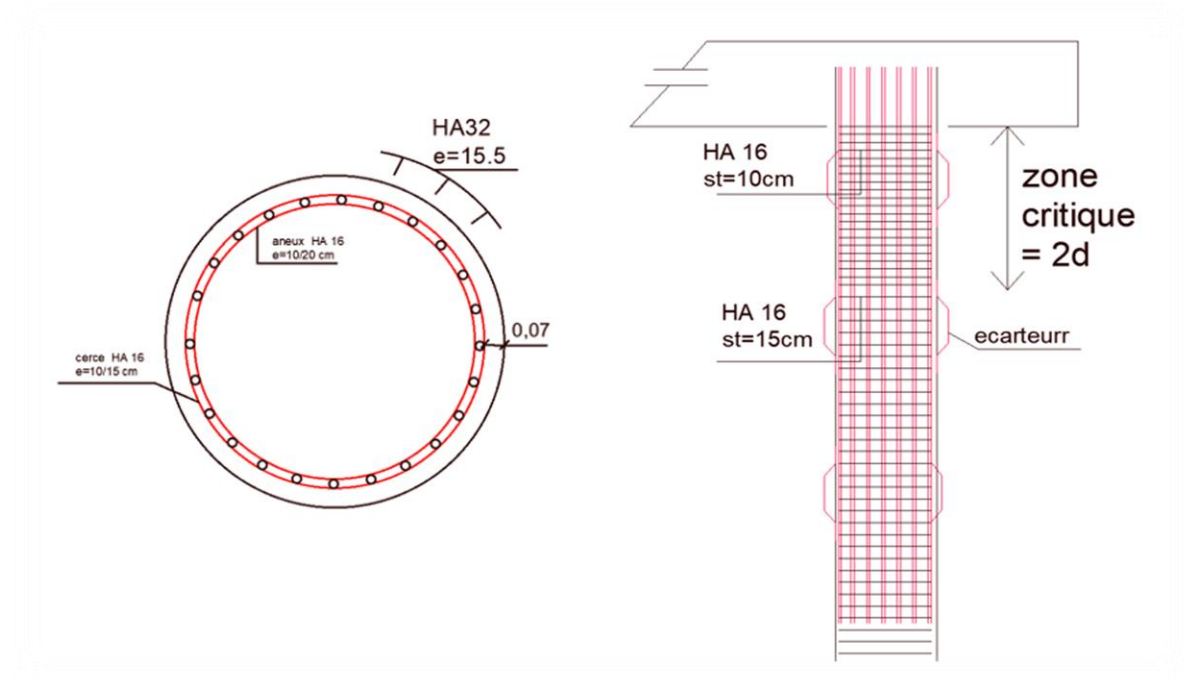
coupe transversal et vue en élévation de ferrailage de pieu
